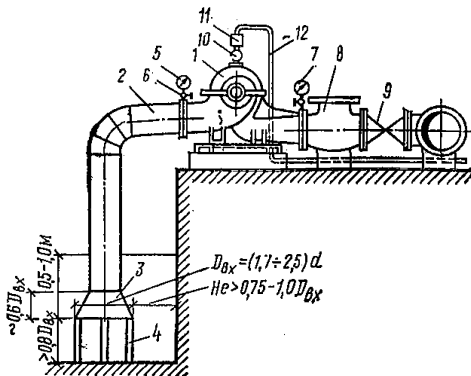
Схема оборудования арматурой горизонтального центробежного насоса
